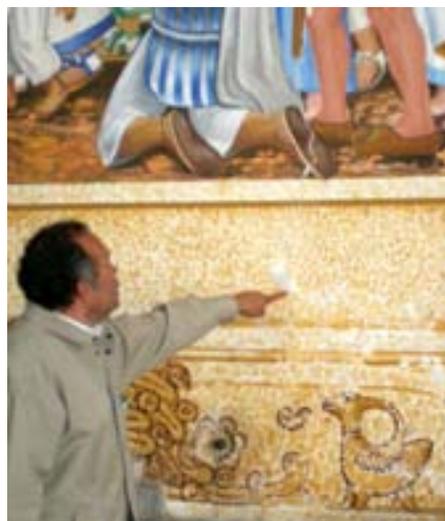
Deterioros; grietas y fisuras en la estructura de muro, así como pérdida de capa pictórica y escamas.
